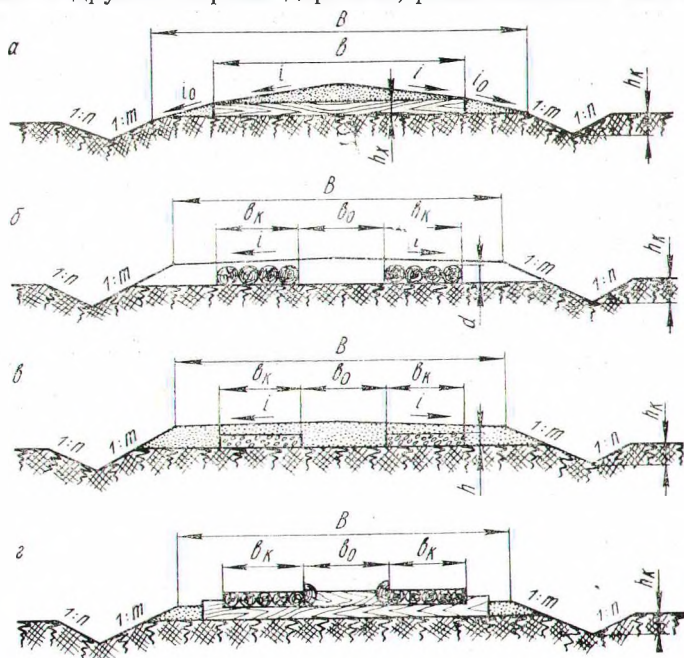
Поперечные профили дорог, проезжая часть которых построена из лесных материалов и грунта. Покрытия: а — грунтово-хворостяное с поперечной укладкой хвороста; б — грунтово-лежневое; в — грунтово-хворостяное с продольной укладкой хвороста; г — лежневое.
